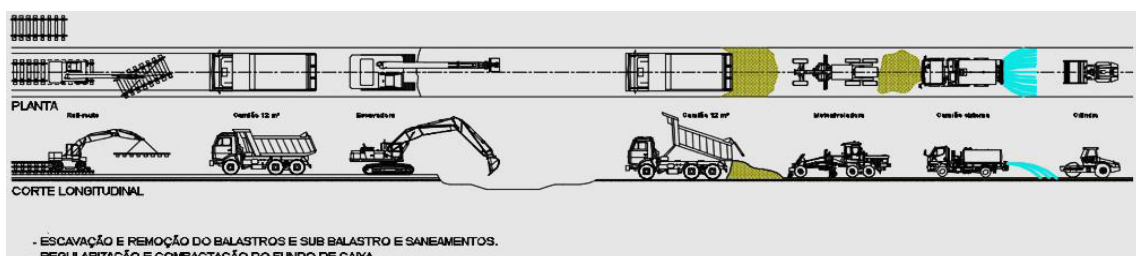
Abertura fundo de caixa e aplicação de camadas de ABGE [41]
